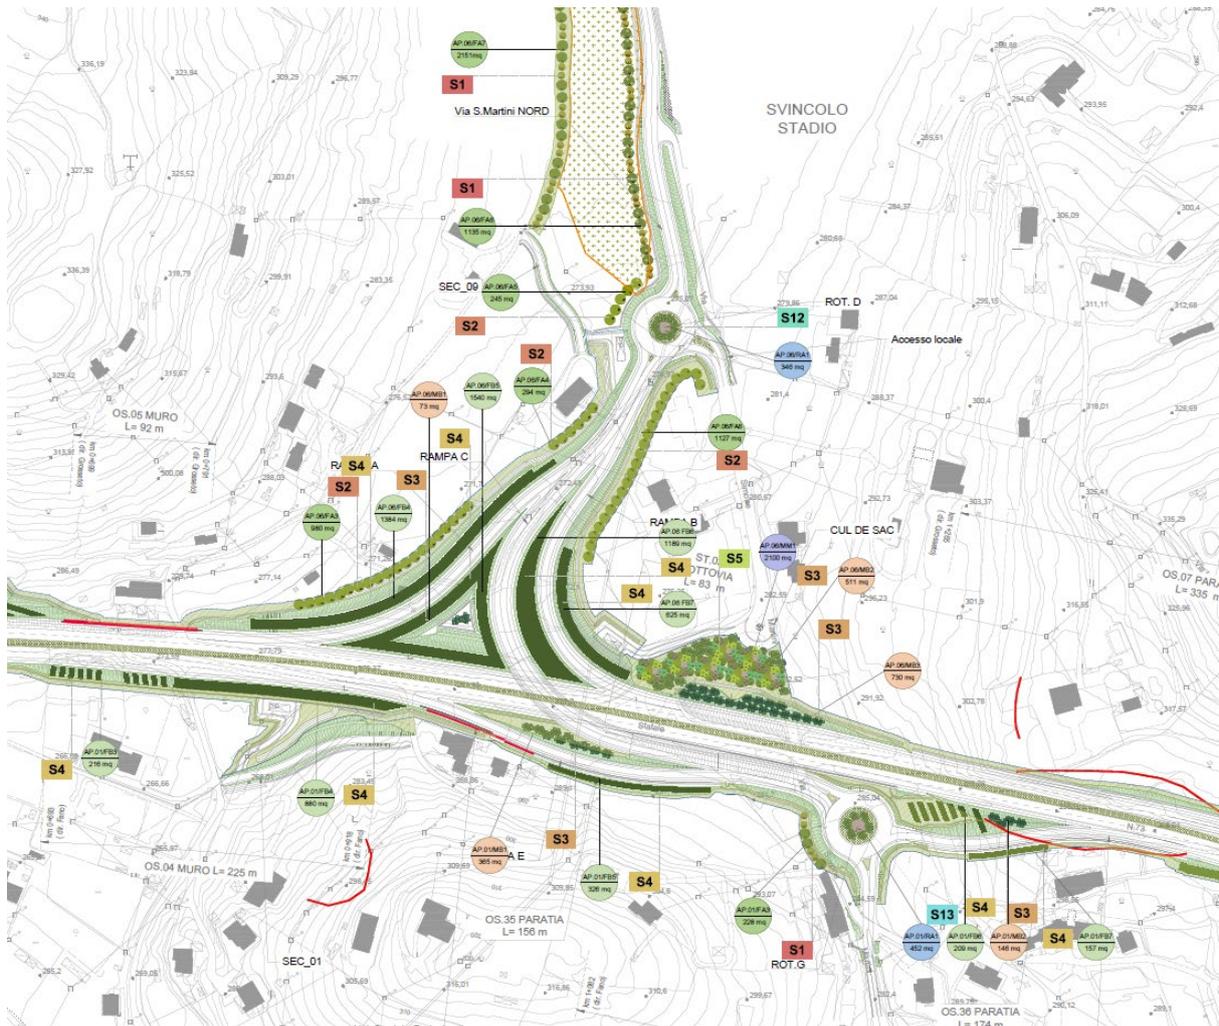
Stralcio della planimetria delle opere a verde, svincolo "Stadio"
